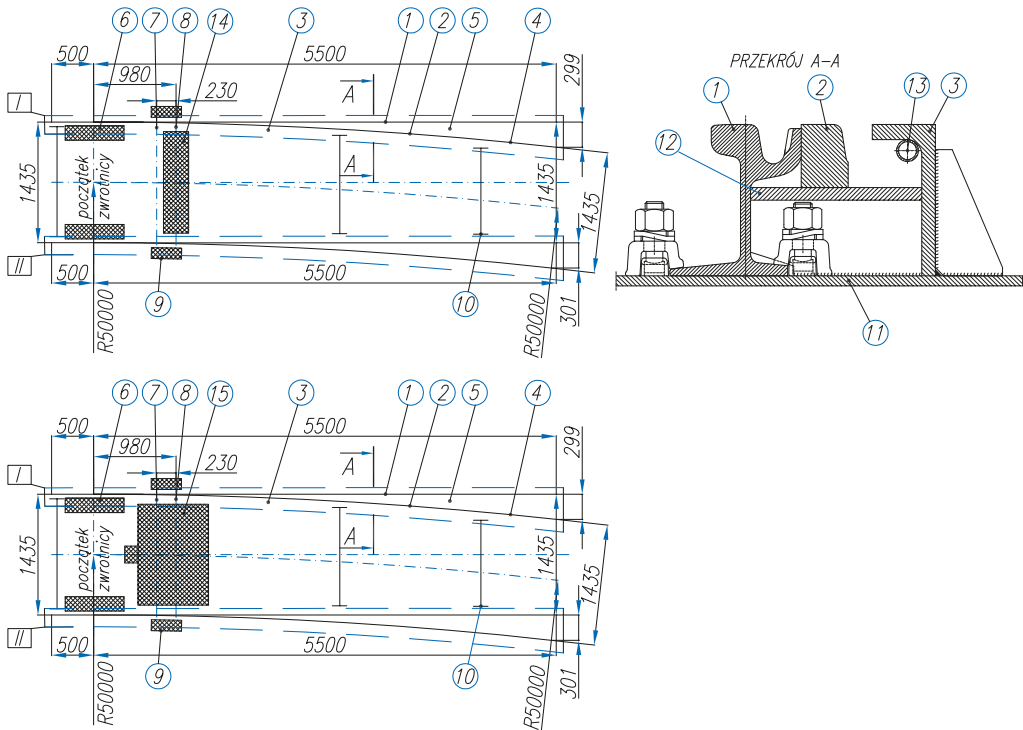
Schematyczny plan zwrotnicy tramwajowej
